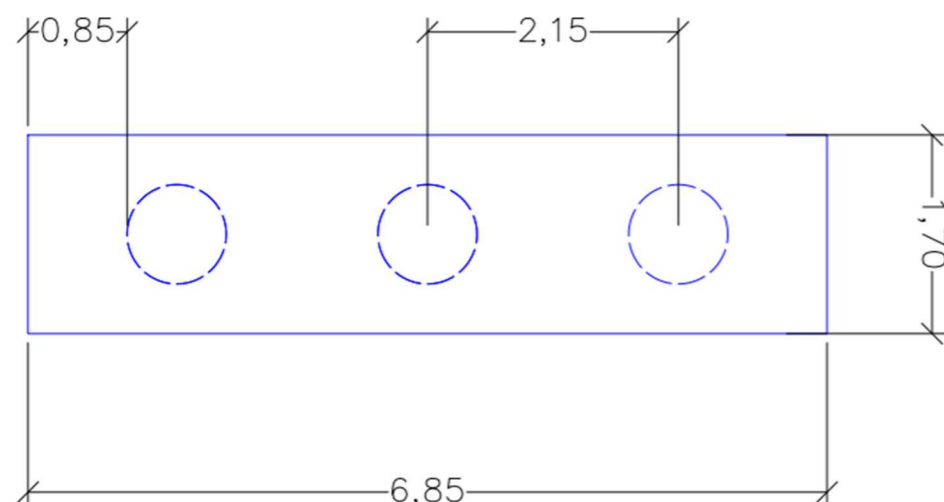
Dimensiones y disposición de los pilotes de la cimentación del estribo 1 en planta, en metros.
